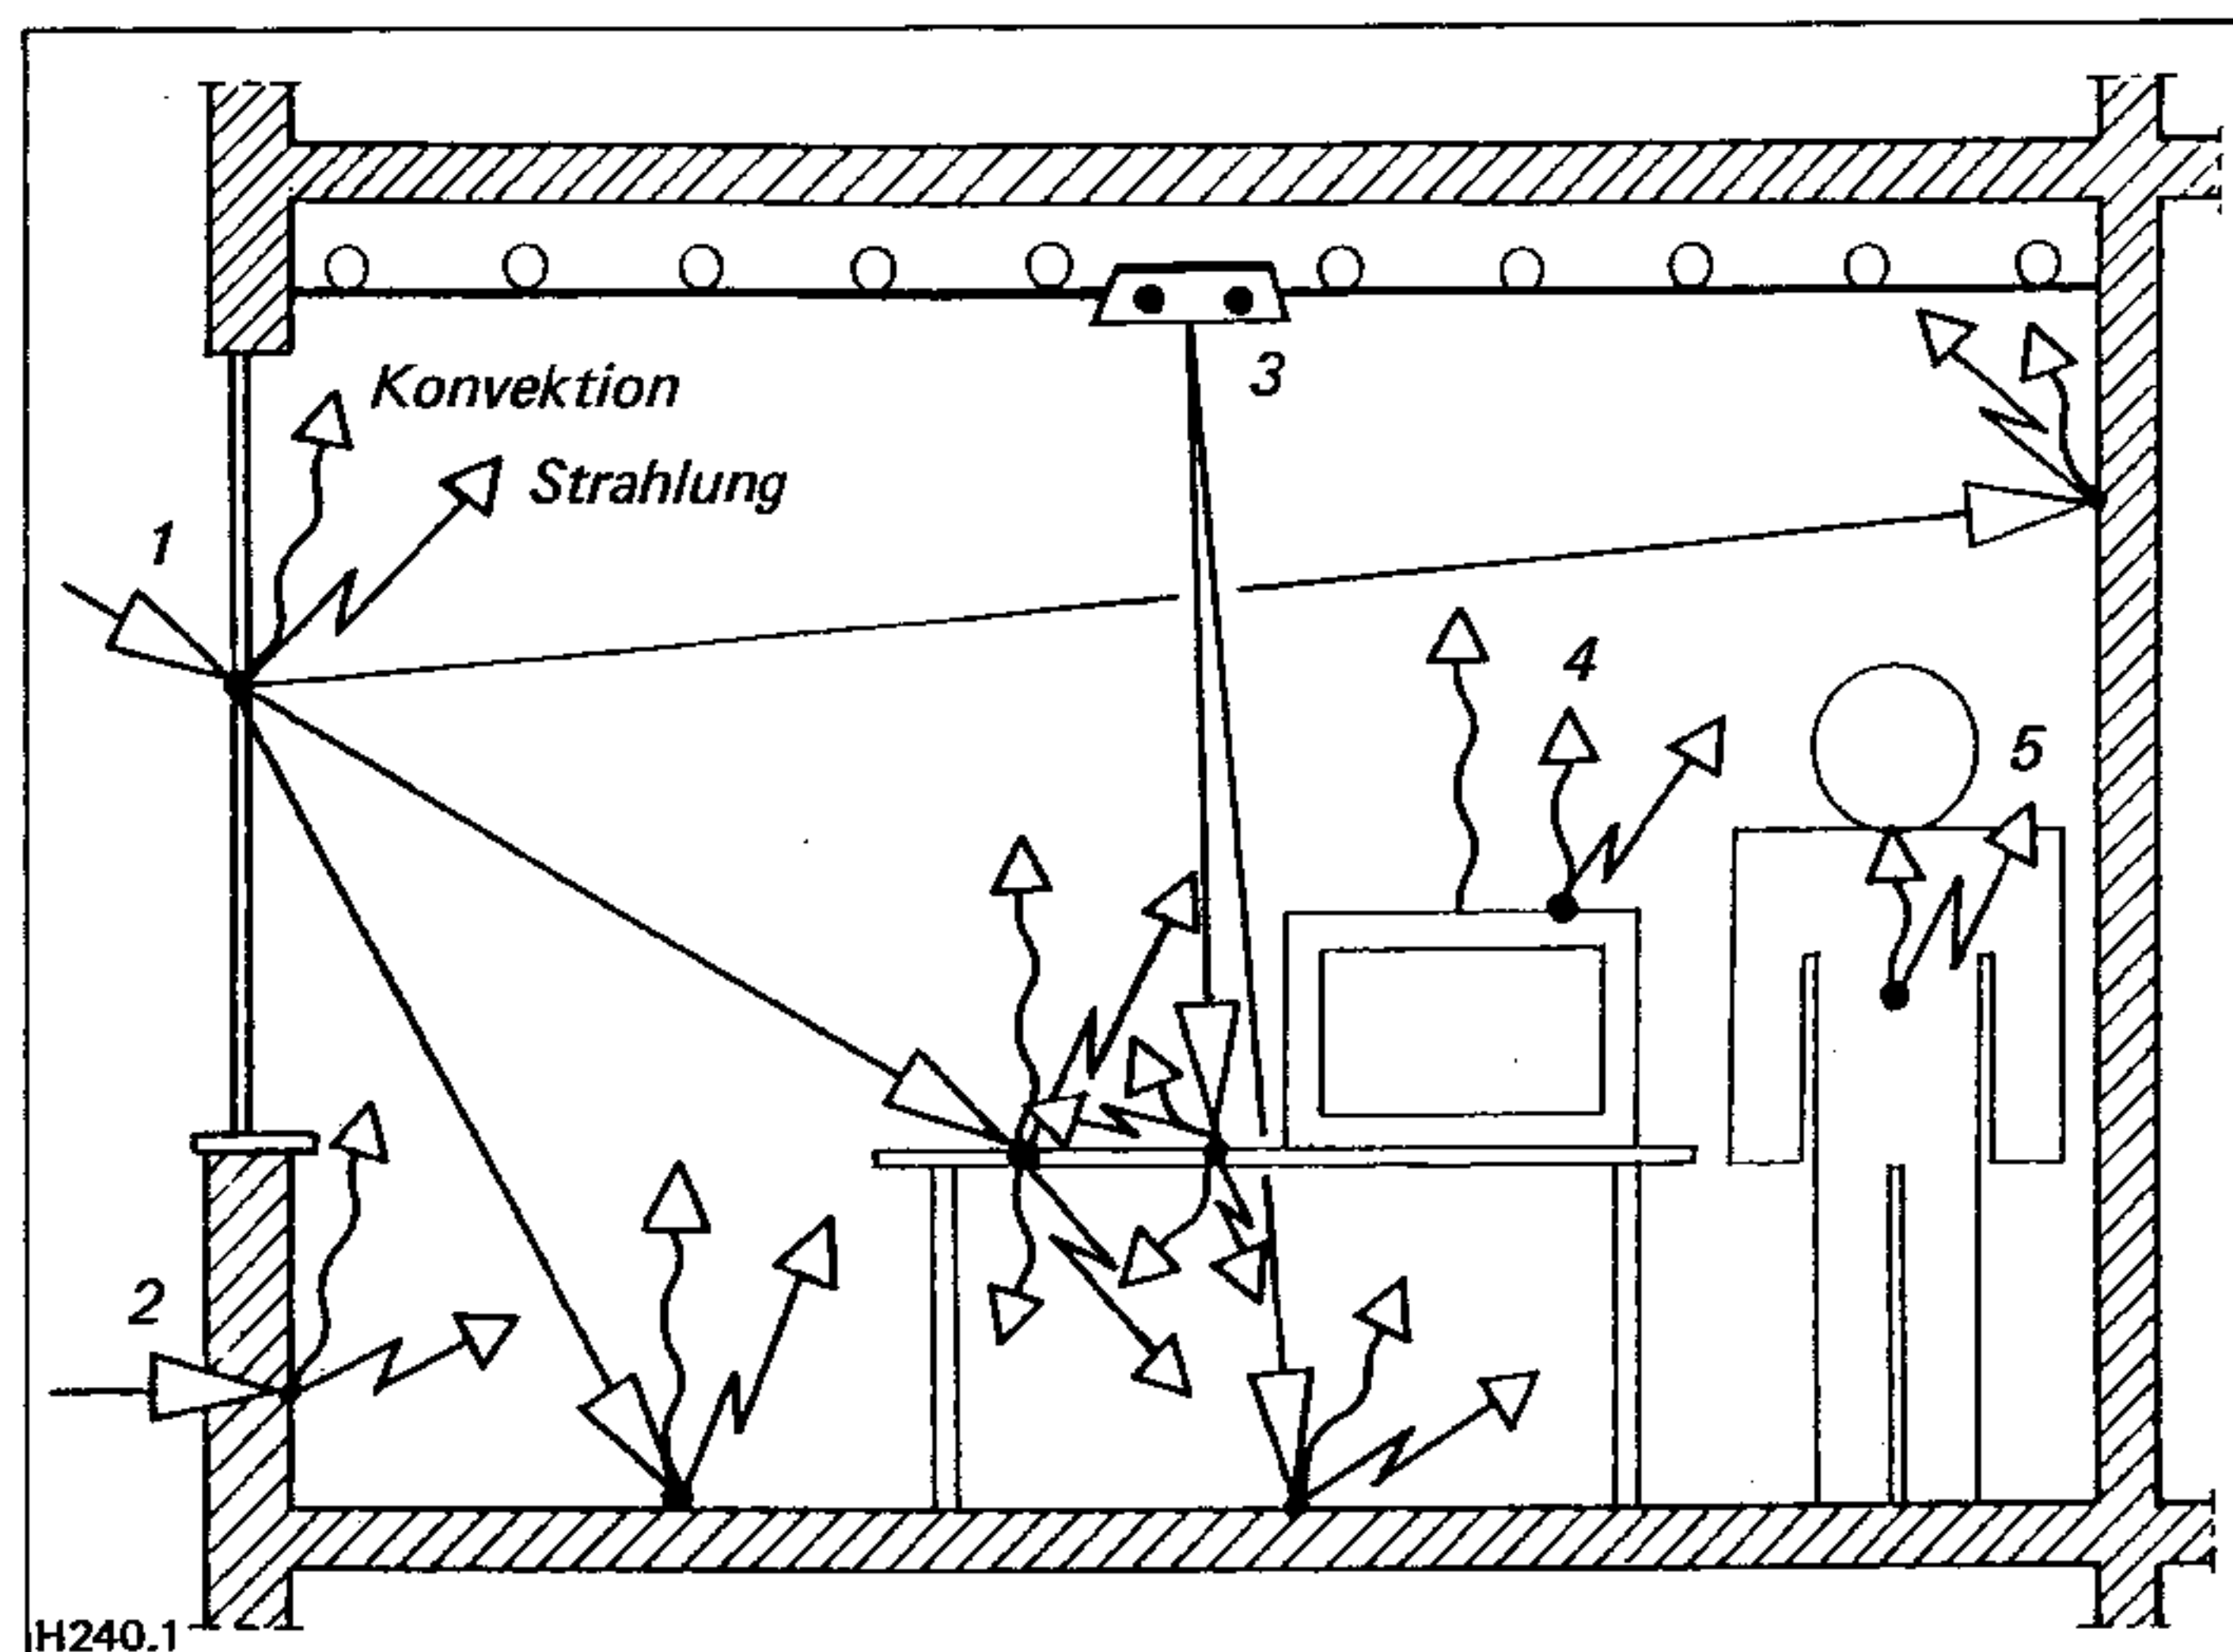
Äußere und innere Wärmelasten in einem Raum mit Kühldecke
